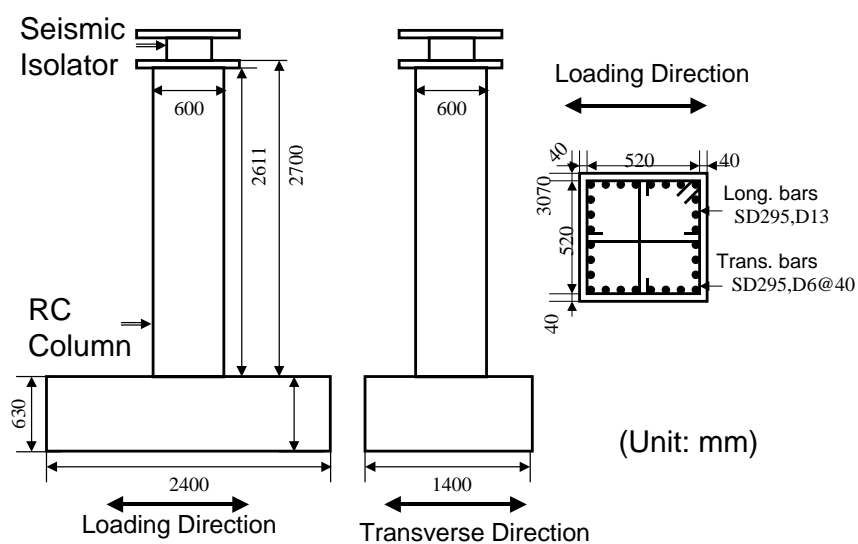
鉄筋コンクリート橋脚模型およびその配筋状況
